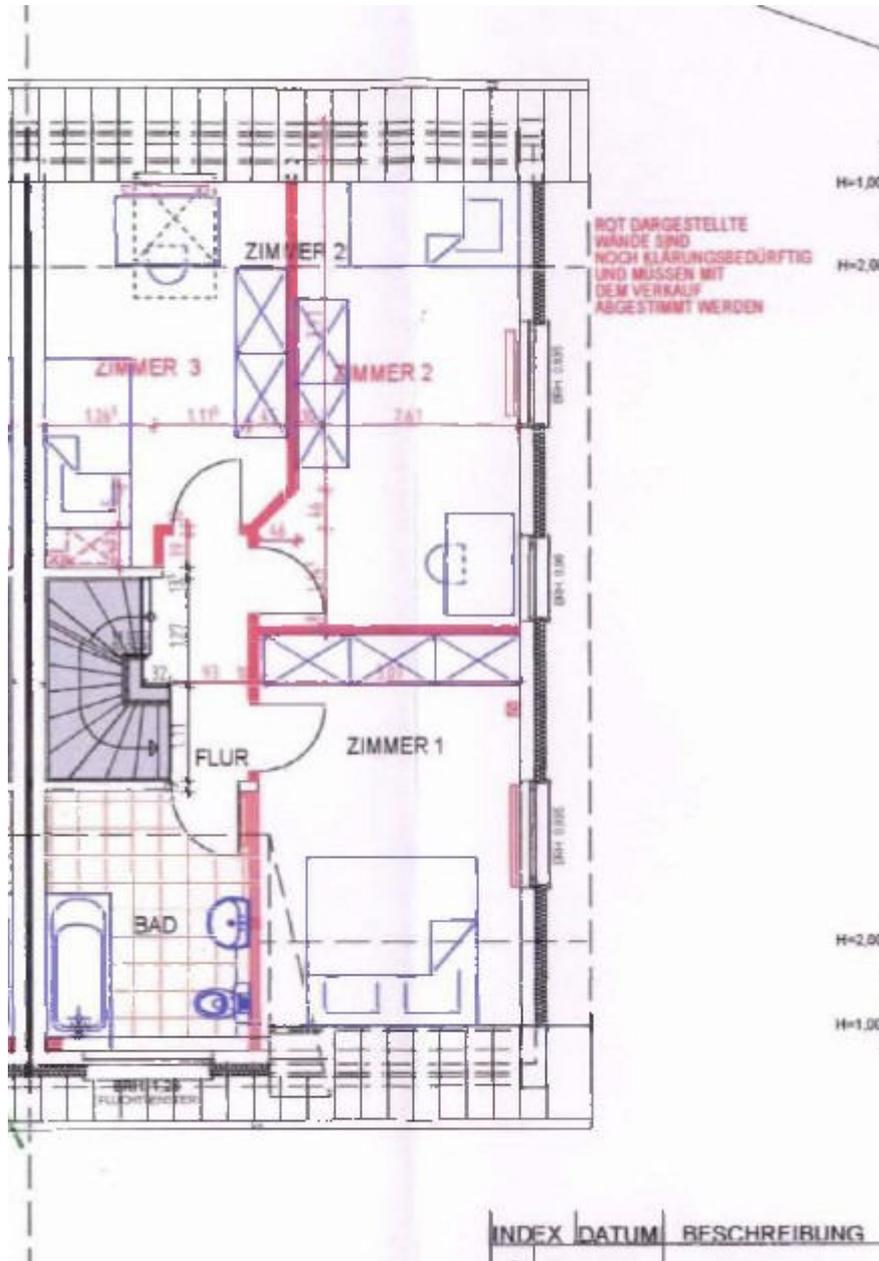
Grundriss 1. Dachgeschoss (Vollgeschoss)
